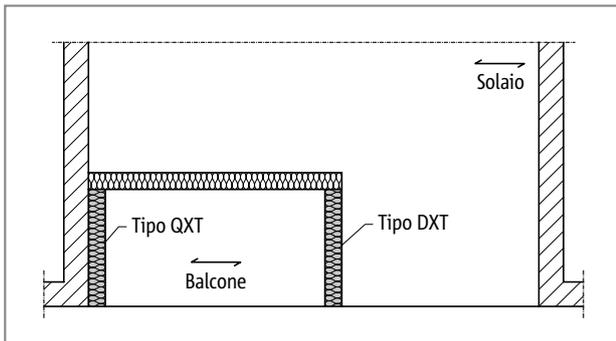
Schöck Isokorb® tipo DXT, QXT: solaio monodirezionale
